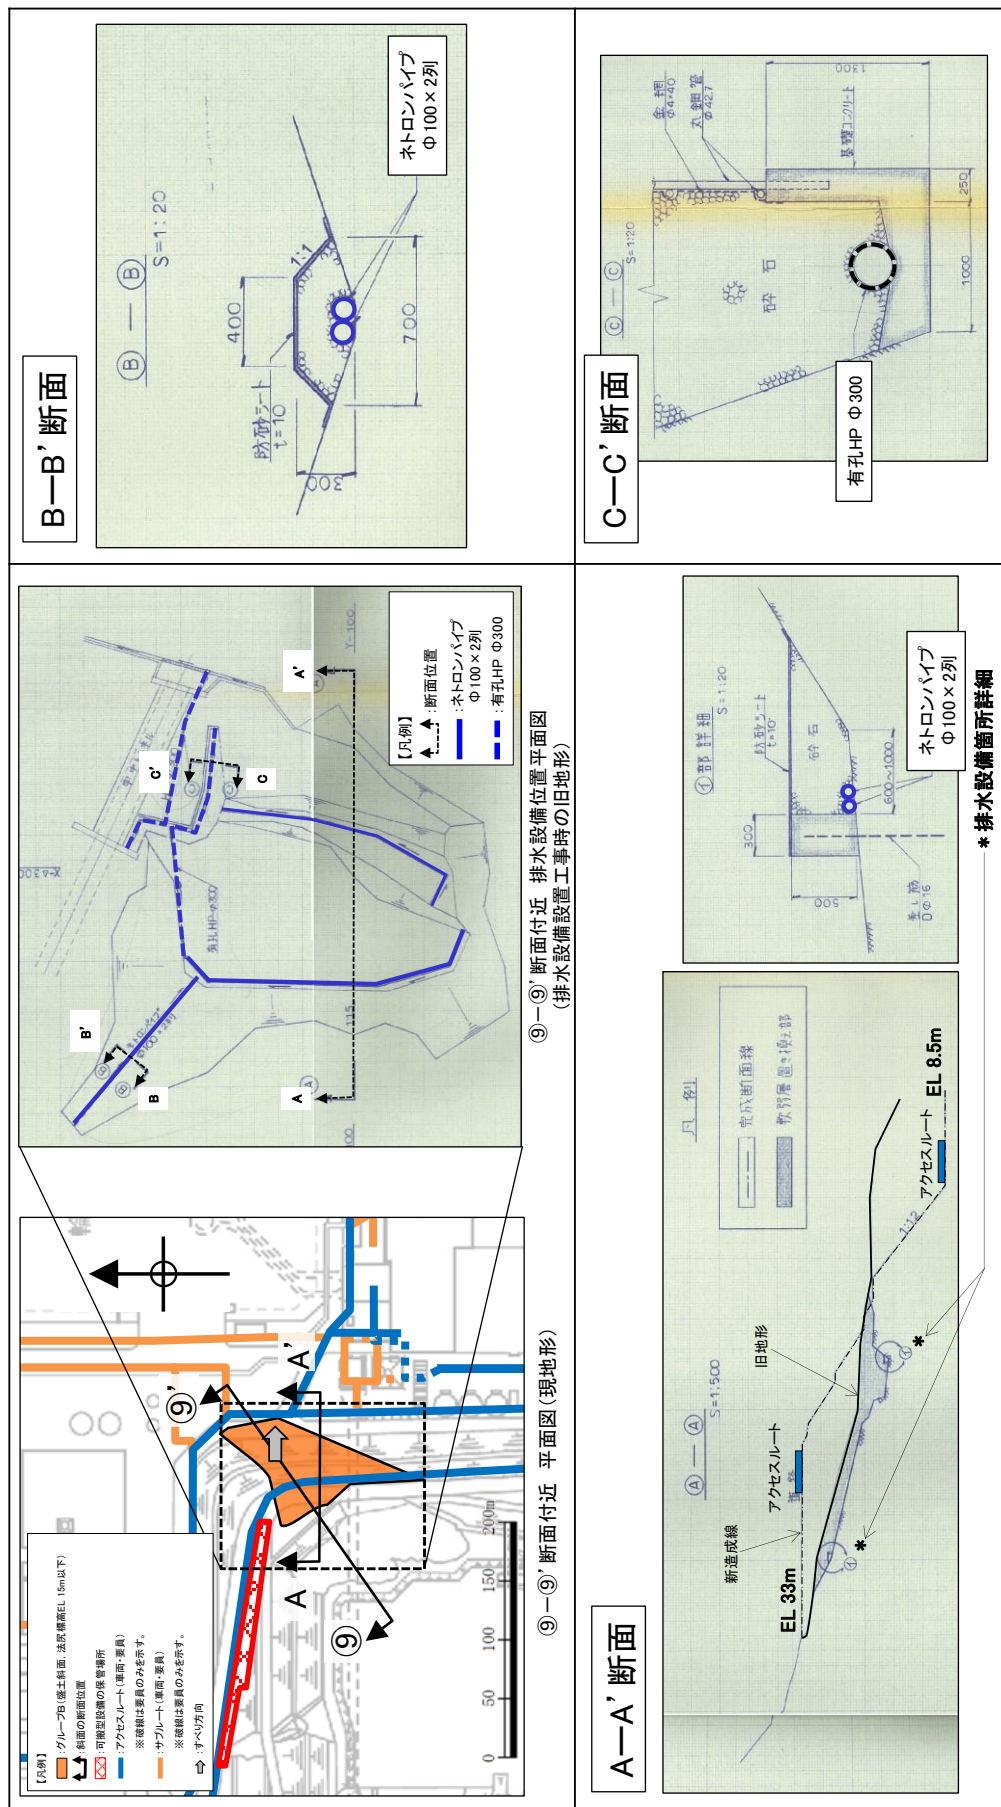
排水設備設置位置 (⑨-⑨' 断面付近)
